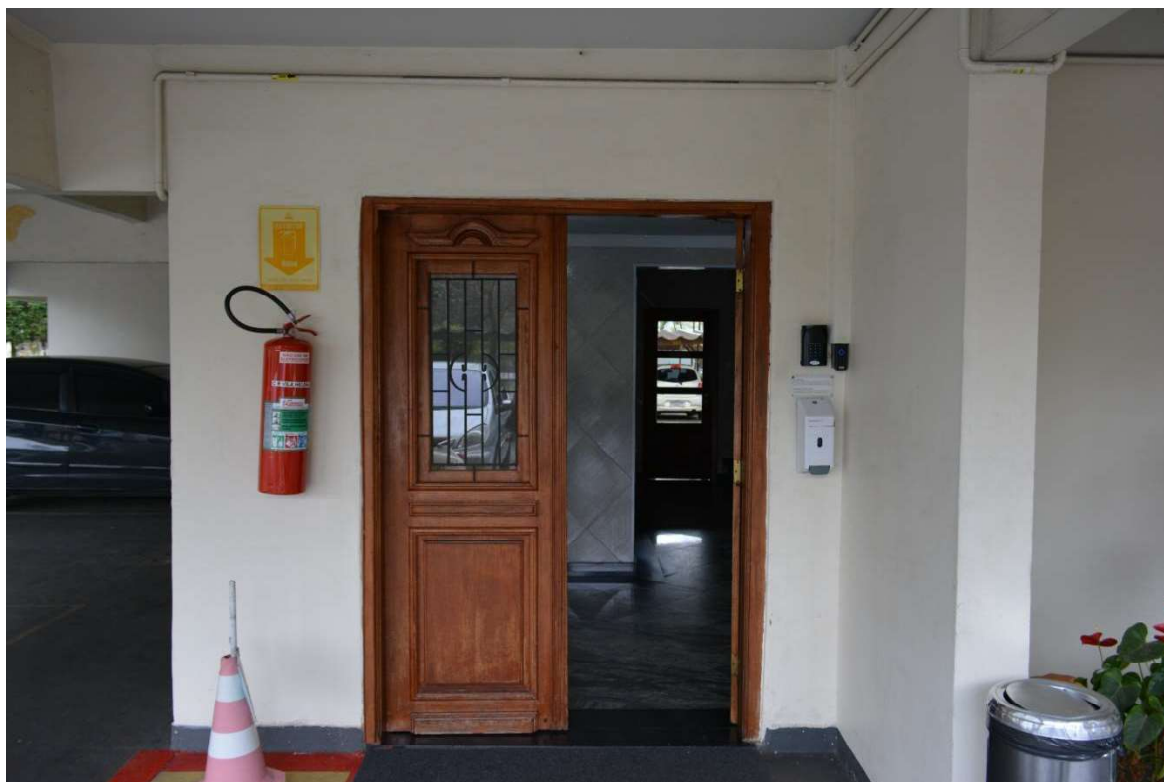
ACESSO AO HALL DO TÉRREO DO BLOCO 2.
